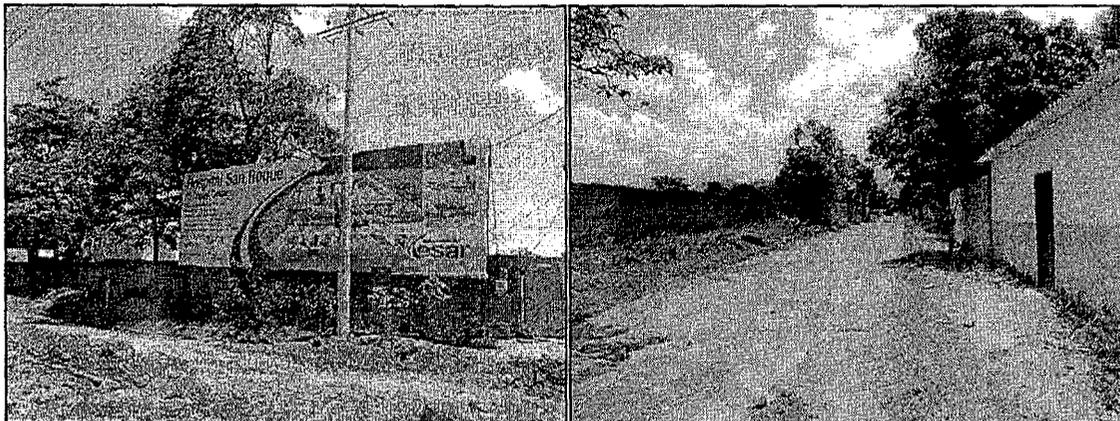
y 3 Obras de pavimentación calle 16 y construcción Hospital San Roque
